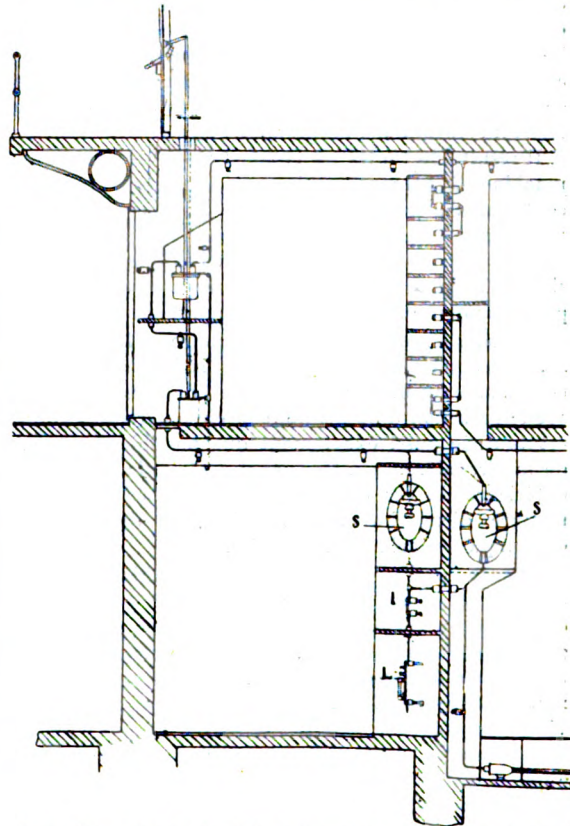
Coupe du châssis haute tension des feeders. L, limiteur de haute tension; S, bobine de self-induction.
